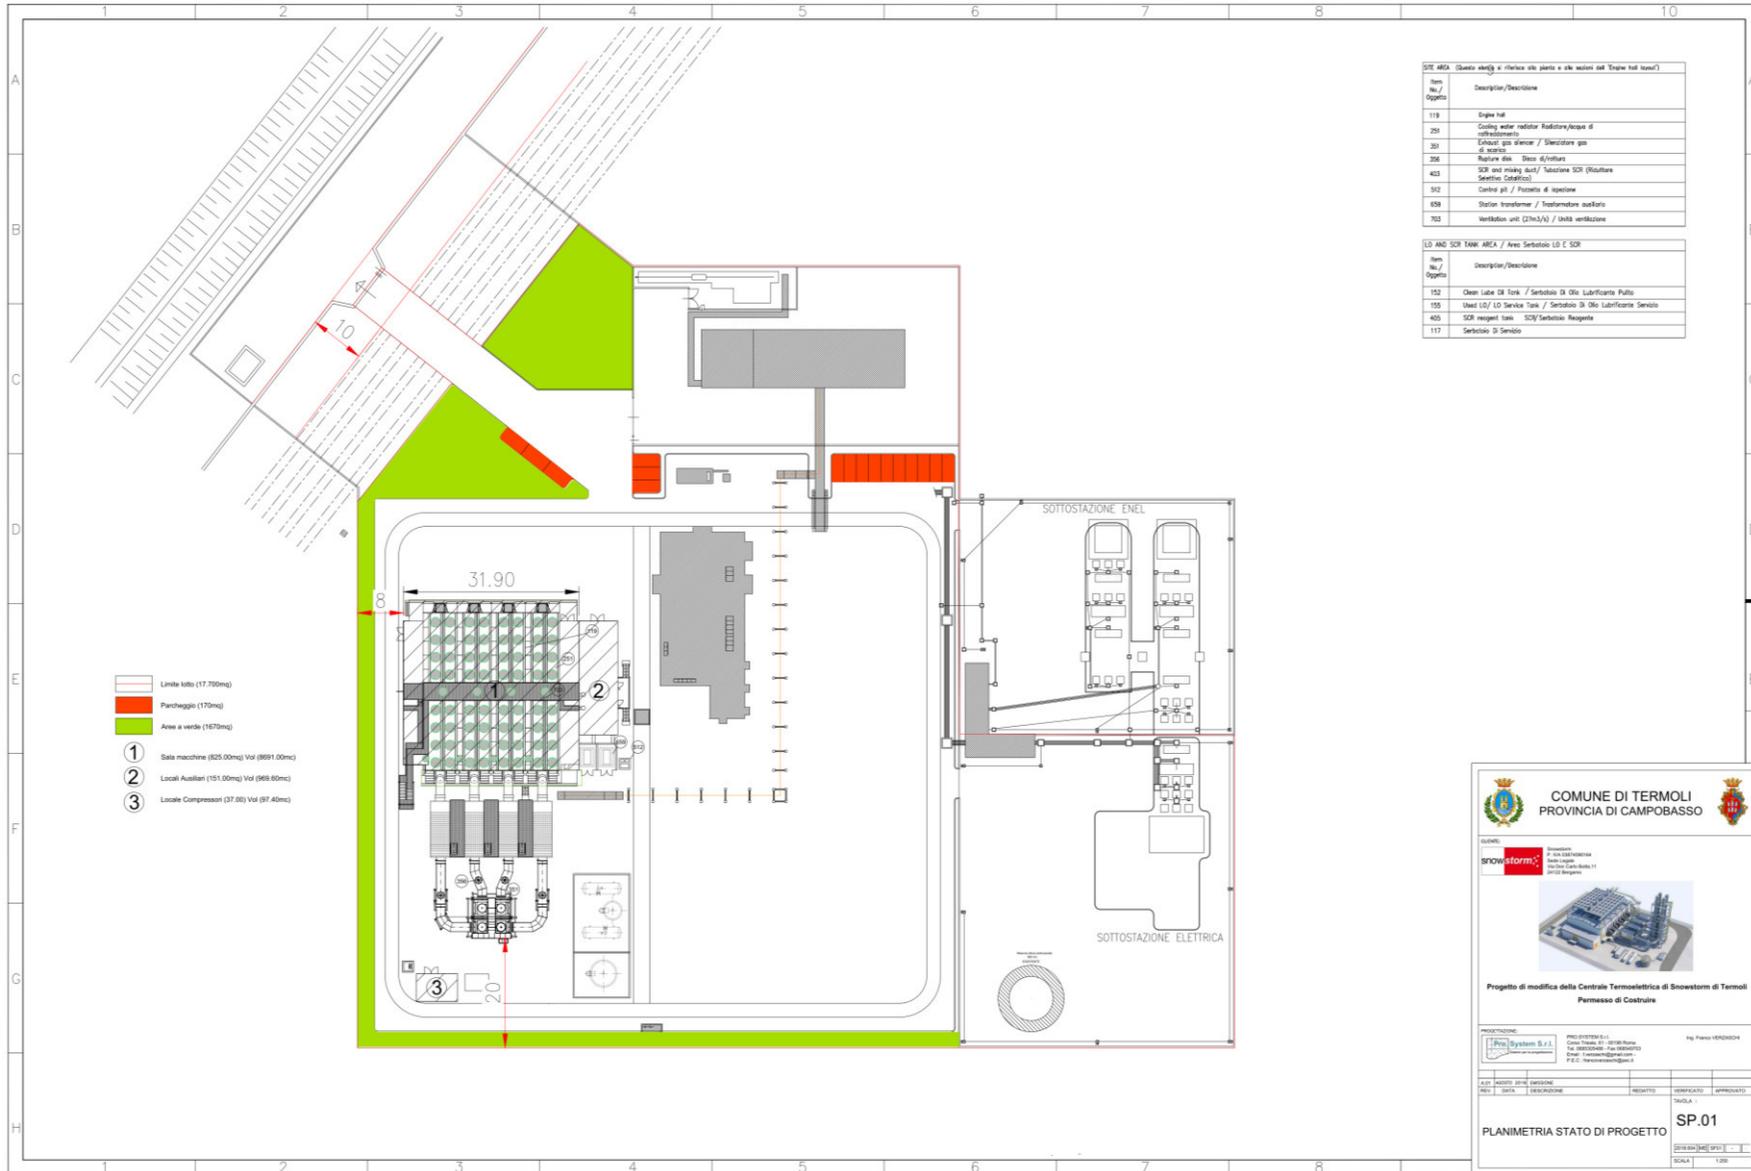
planimetria generale dell'installazione: assetto "post operam"
